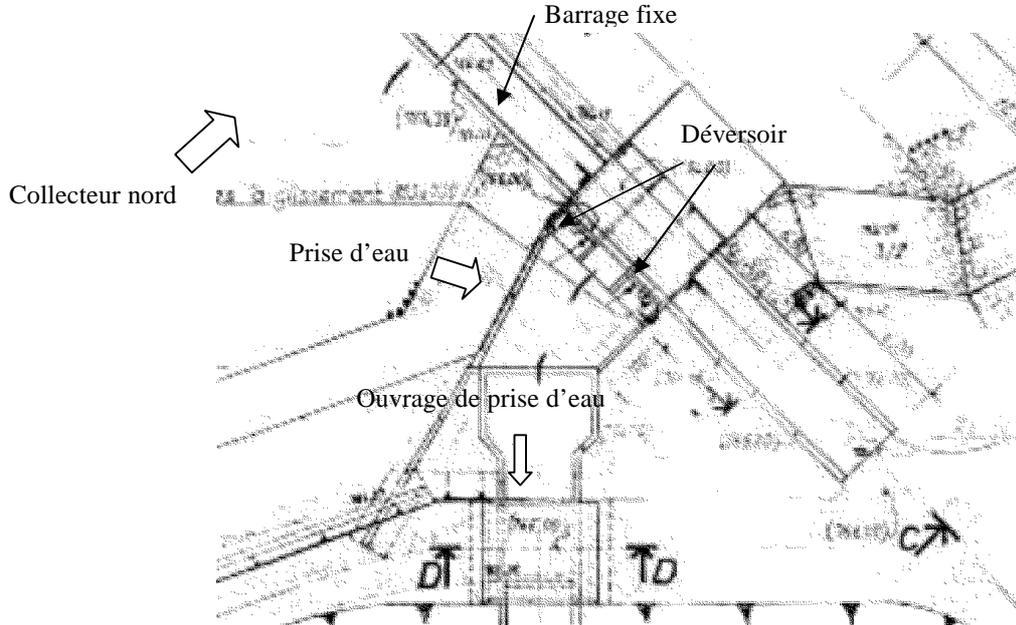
Plan de masse de la tête de prise existante d'Andranotsimihoatra
